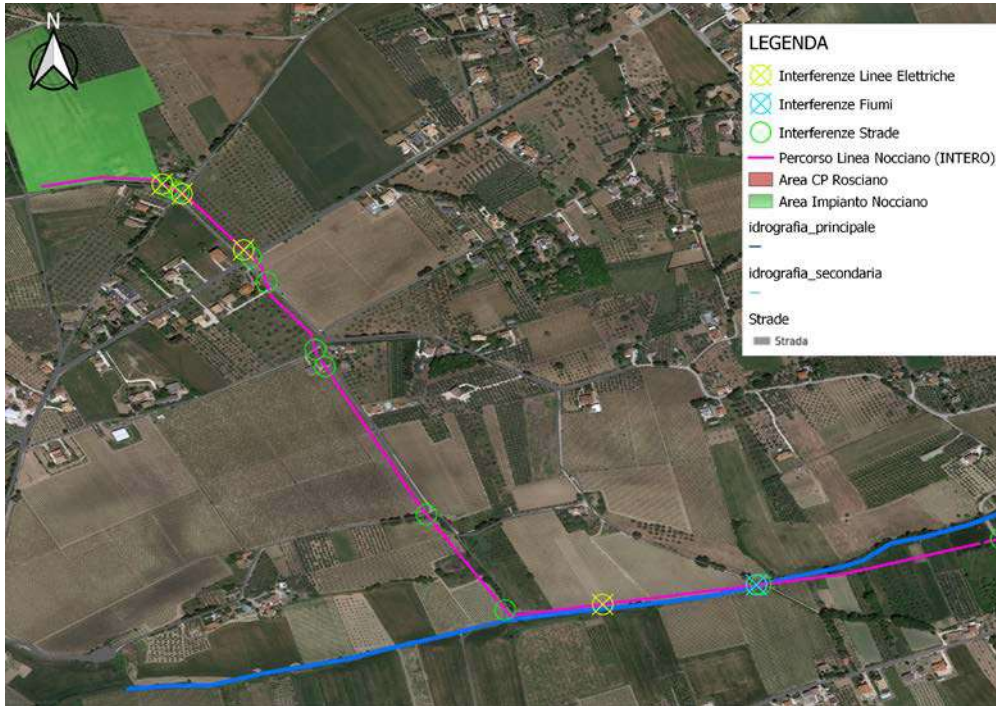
PLANIMETRIA INTERFERENZE N. 1 DI 4
